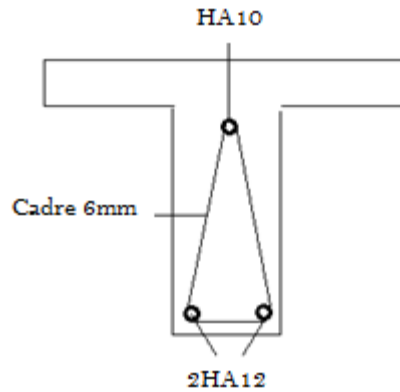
Schéma de ferrailage des nervures du plancher terrasse.
